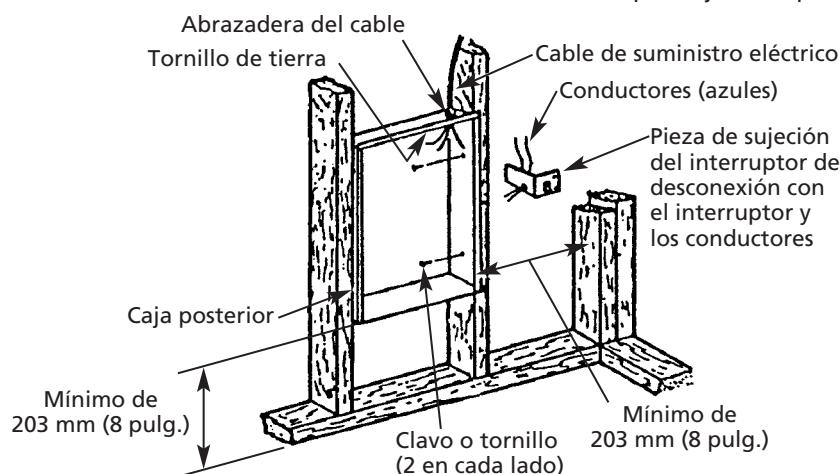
Montaje de la Caja Posterior en una Construcción Nueva
